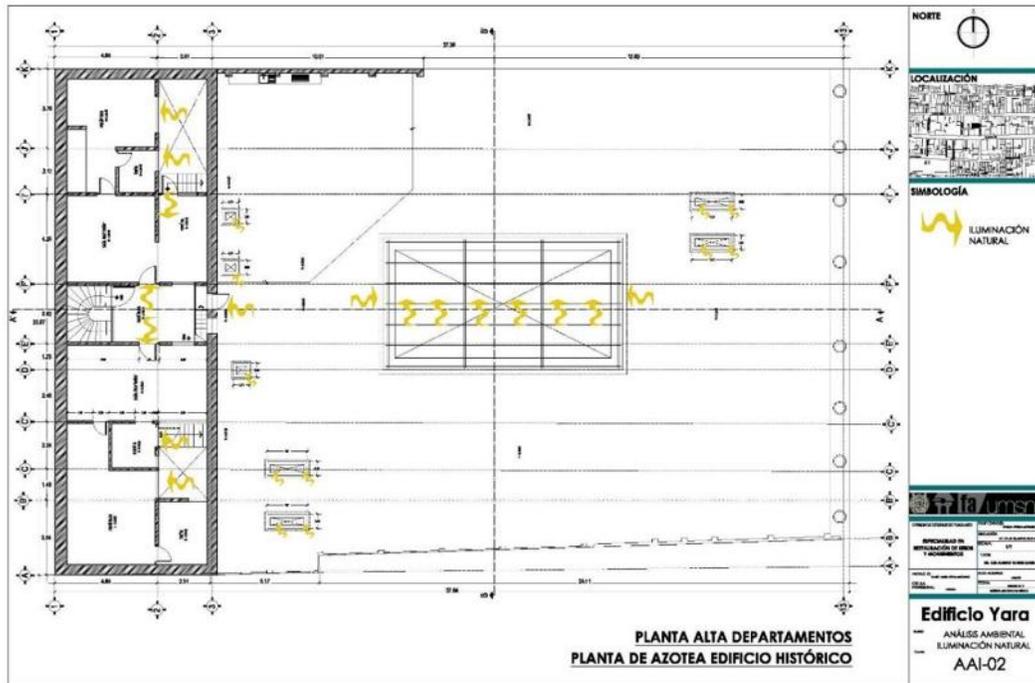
Plano de análisis de iluminación natural. Planta Alta departamentos y planta de azotea de edificio histórico.
